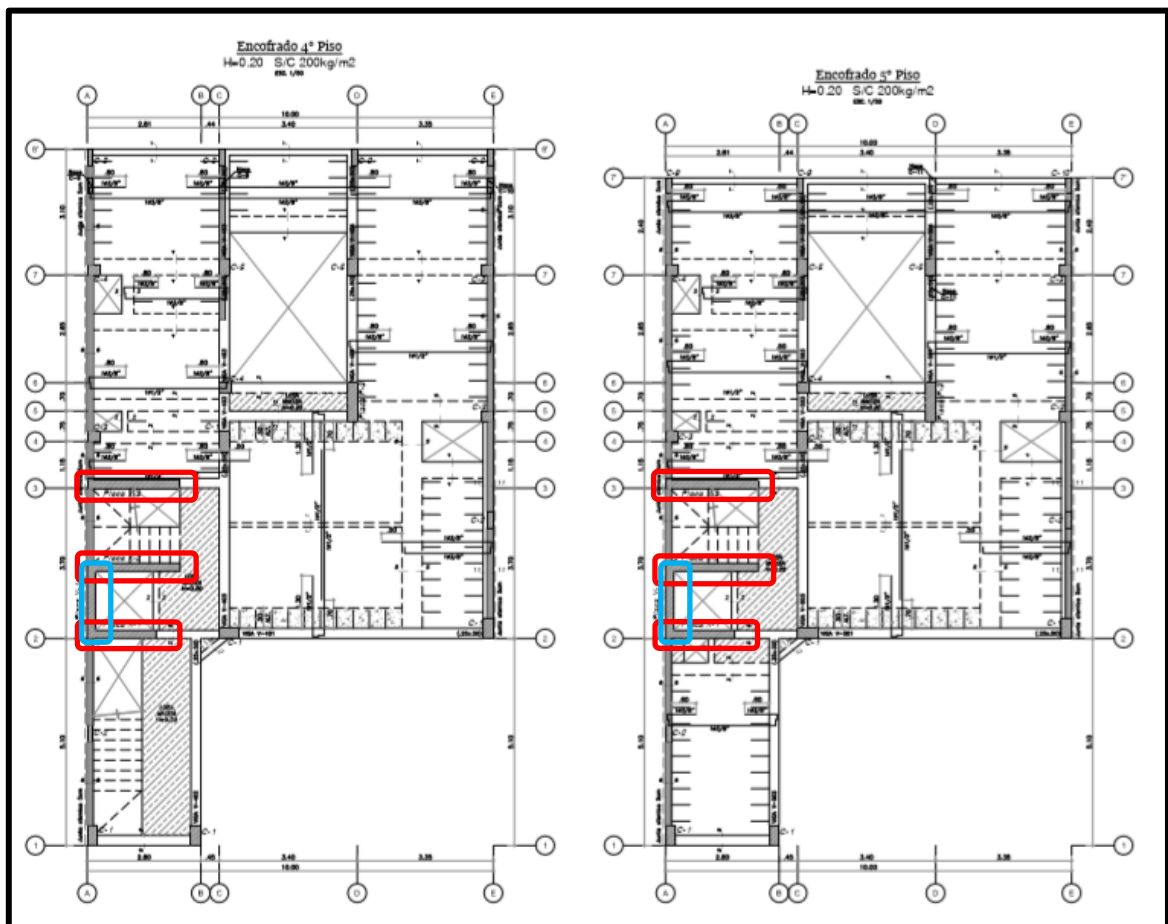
Propuesta de Sistema de Muros Estructurales, 4° y 5° piso. Se encerraron en rectángulos color rojo las placas propuestas para el eje X y en rectángulos color celeste las placas propuestas para el eje Y.
